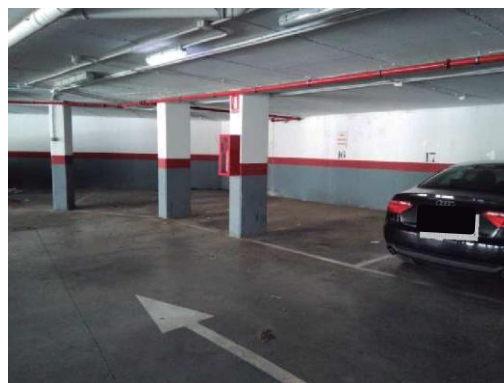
Aparcamiento Las Canteras. Planta exterior y bajo rasante
